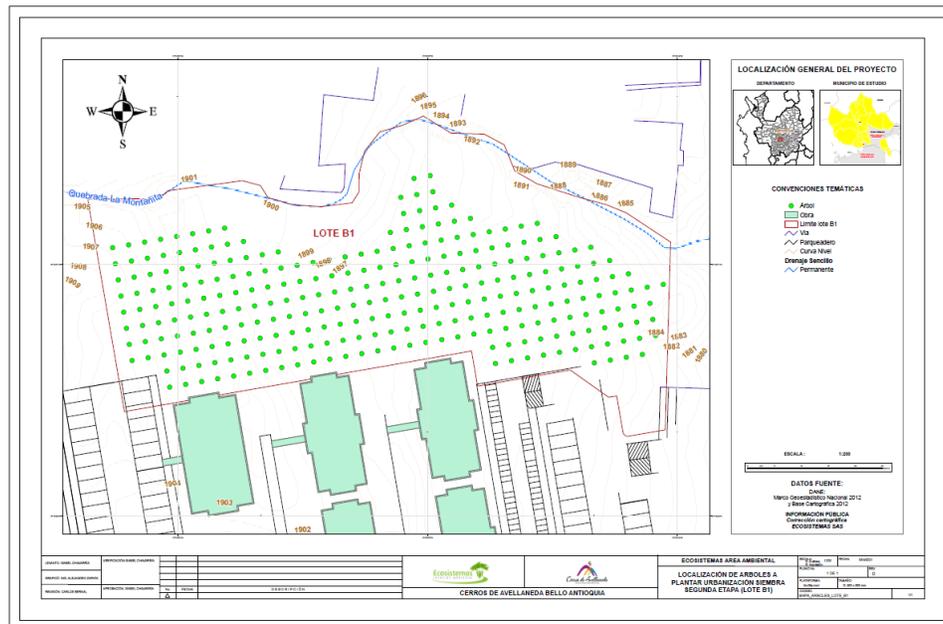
Plano de ubicación de la propuesta de reposición Unidad Residencial Siembra – LOTE B1
